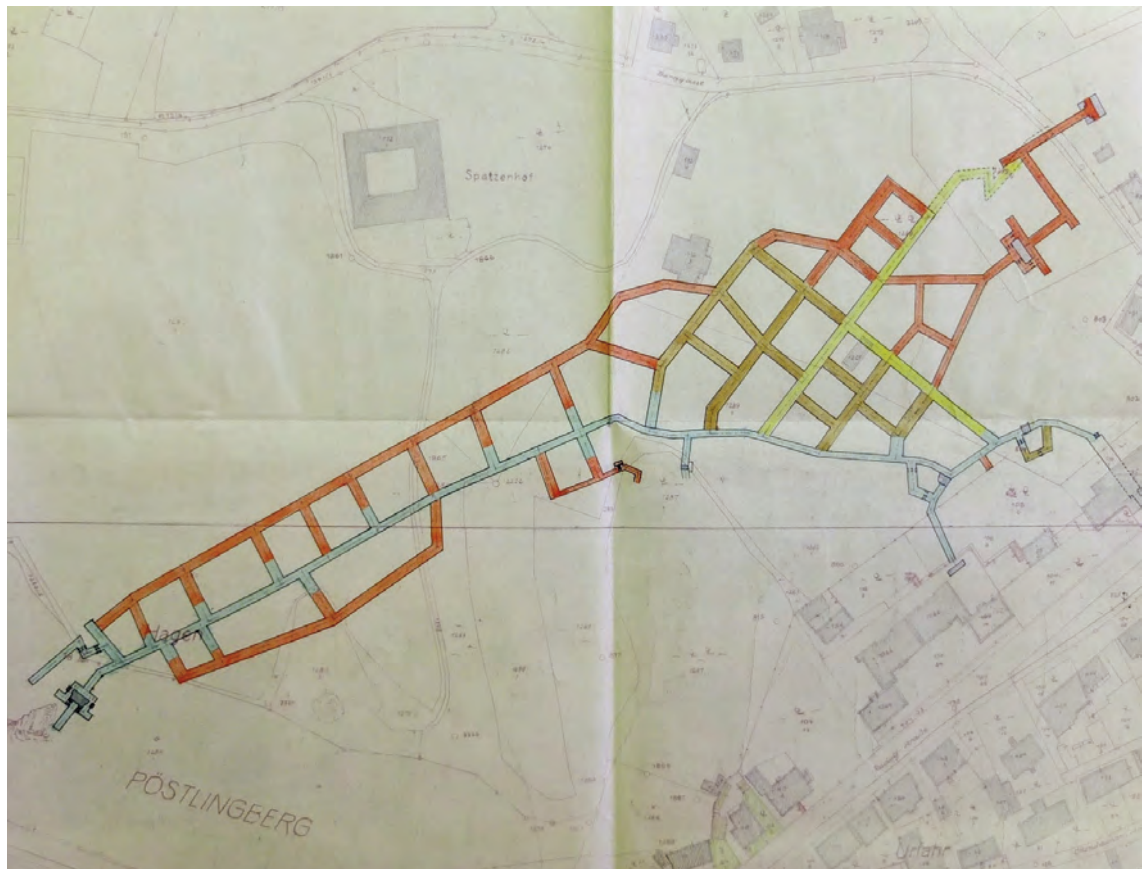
Erster Ausbauplan, blau: ursprüngliche Ausbaustufe, gelb: Ergänzung II Ausbauplan Tiefbauamt, braun: Ergänzung III Ausbauplan Tiefbauamt, rot: Ergänzung IV Ausbauplan Planungsamt auf einer Karte im Archiv der Stadt Linz.
